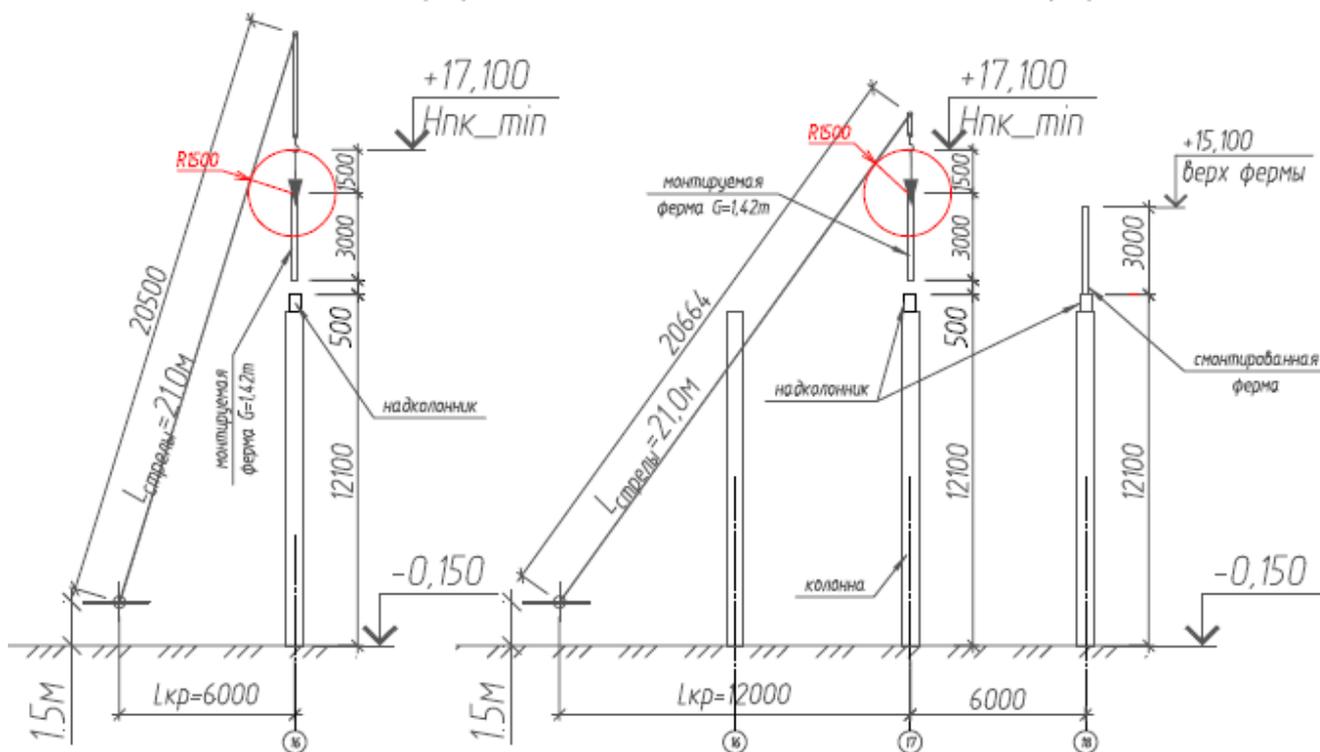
Графическое определение высоты поднятия крюка, длины и вылета стрелы крана при монтаже ферм в пролете В-Г
